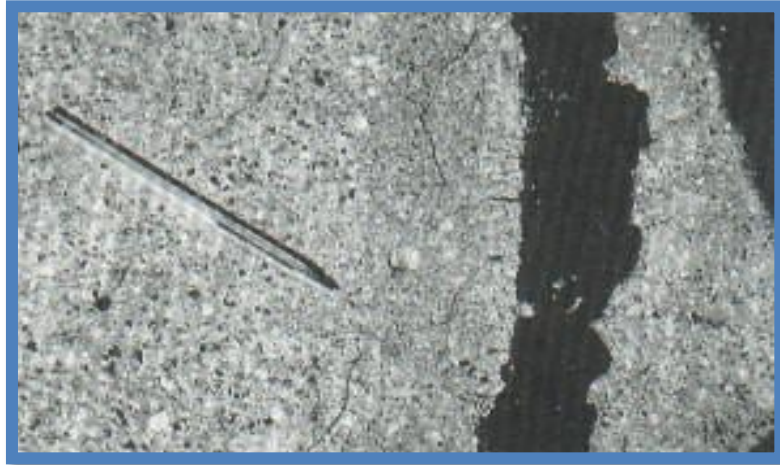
Grieta de durabilidad “D” de baja severidad.
